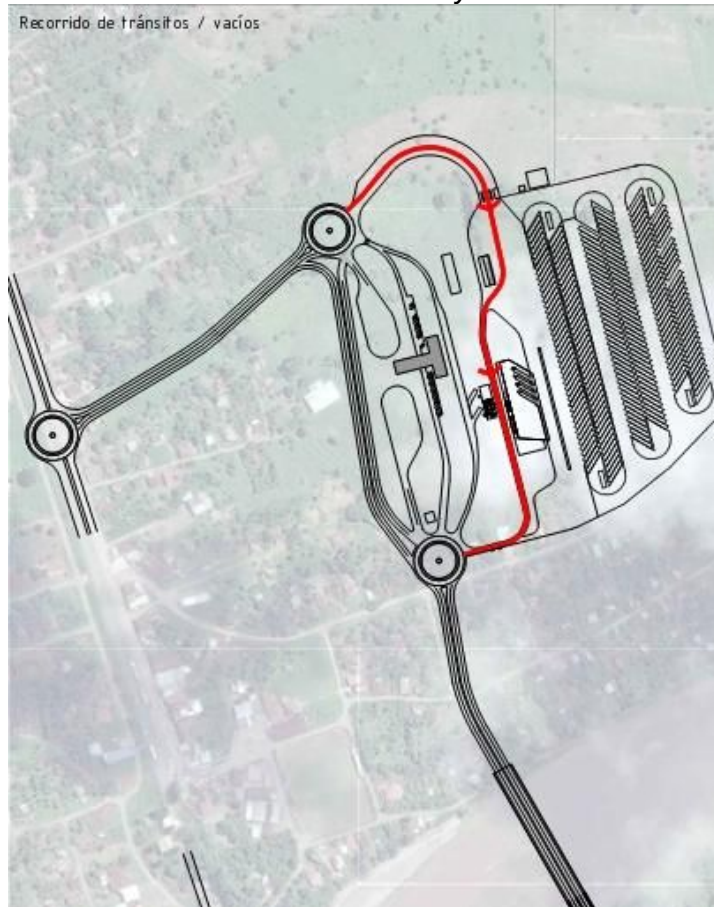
Plano de recorrido de cargas – Alternativa 1 (CR)
